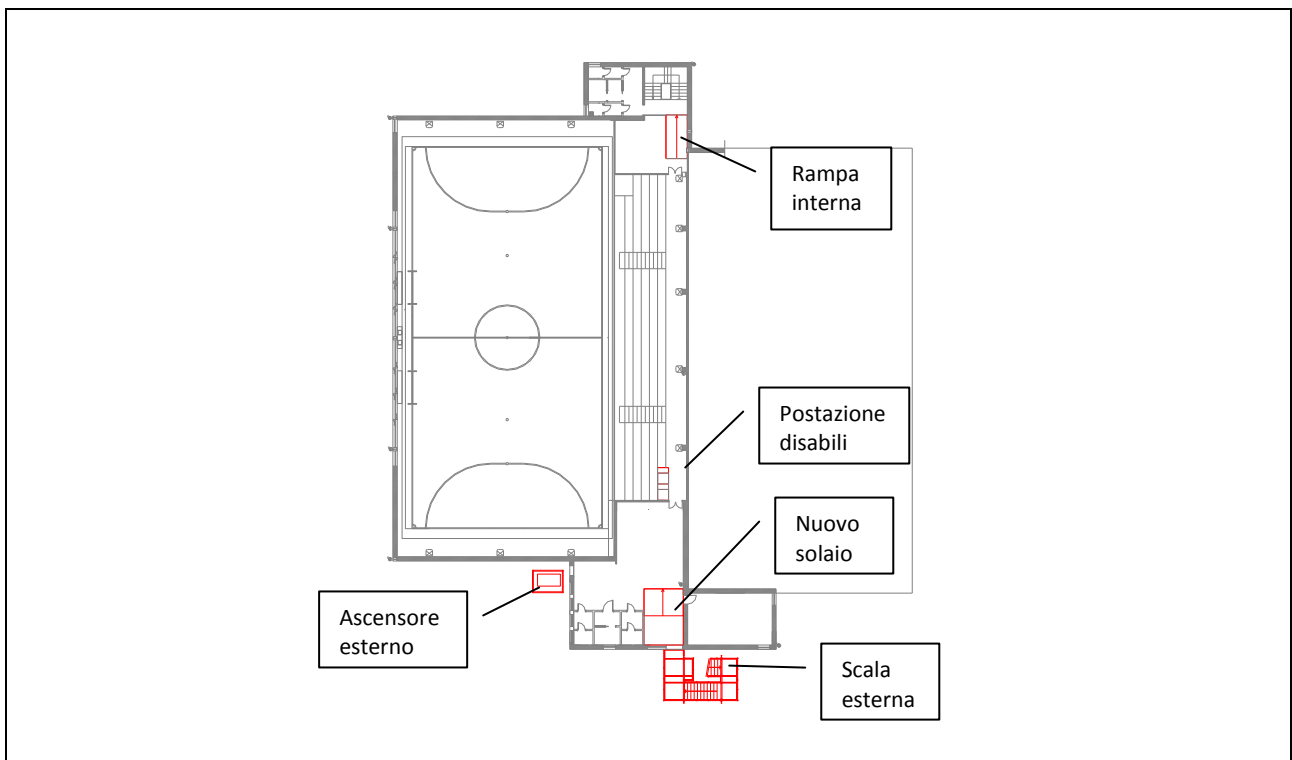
Pianta chiave primo piano con indicazione degli interventi in progetto
